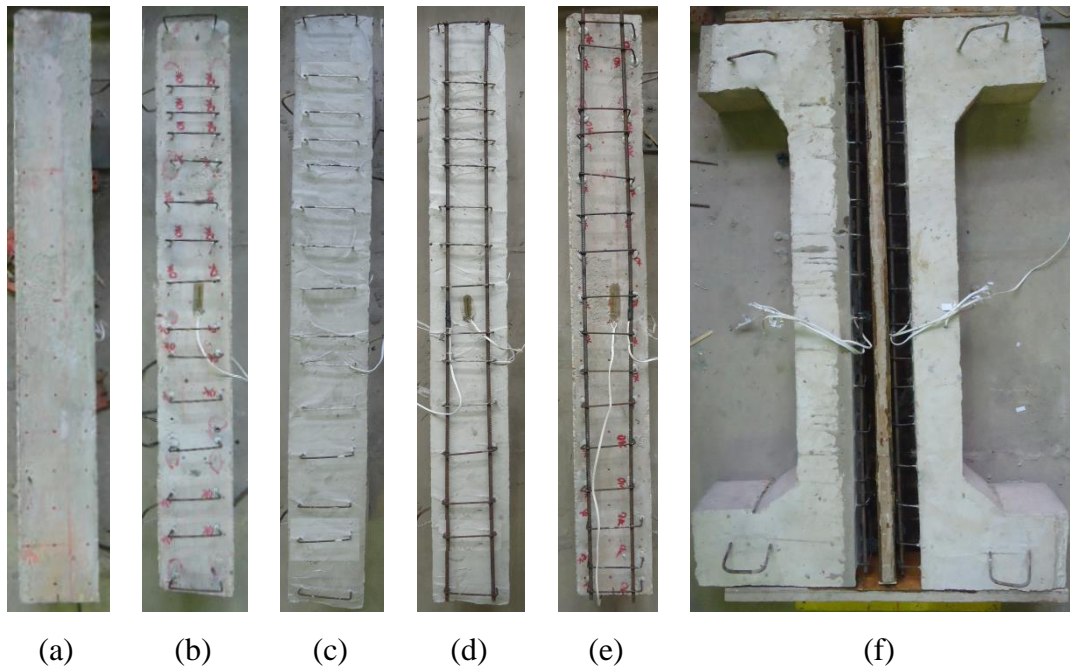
Etapas do reforço dos pilares reforçados á tração
